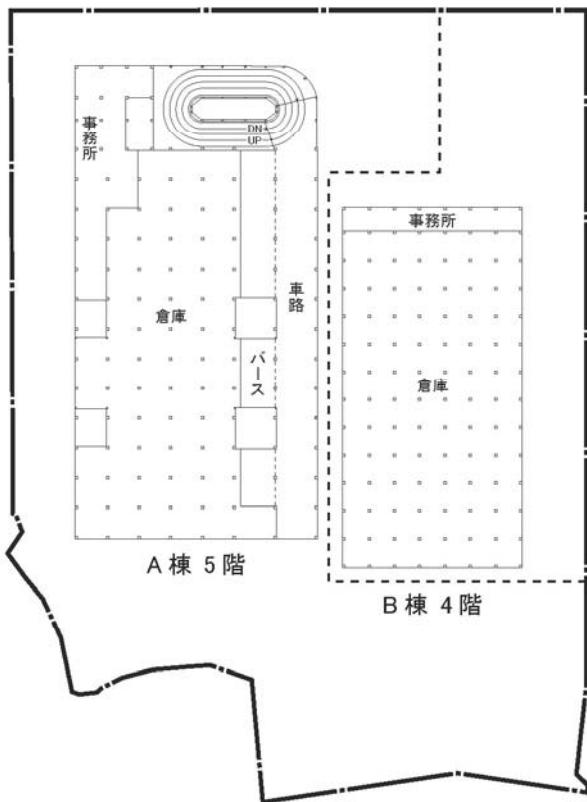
(3) 計画建築物平面図 (A棟5階・屋上階、B棟4階・屋根)
